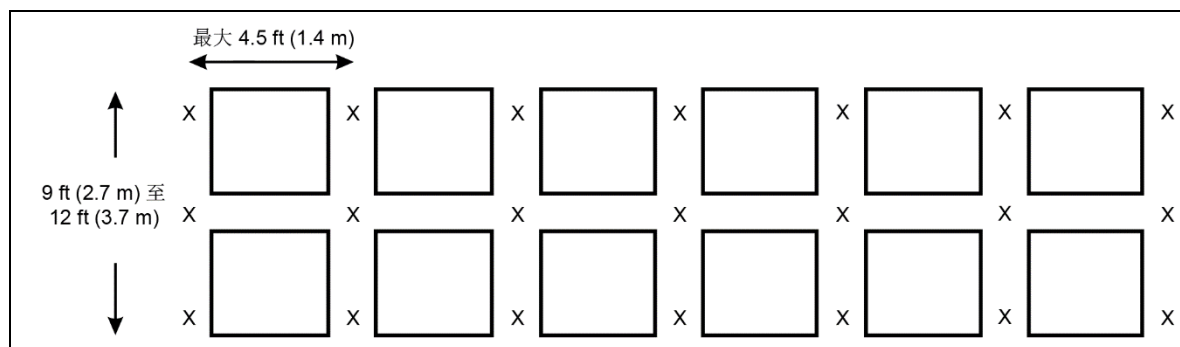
进深不超过 12 英尺 (3.7 米) 双排货架的备选货架内喷头布置平面图
